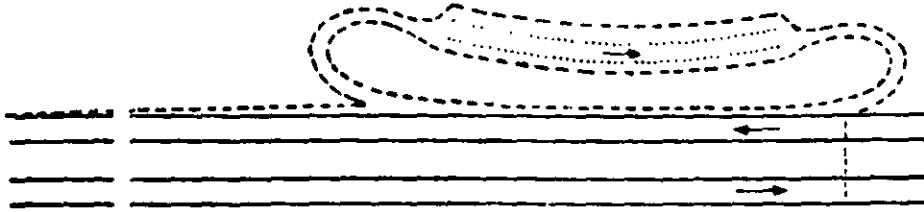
ZONA DE DESCANSO APROPIADA PARA CAMINOS CON BAJOS VOLUMENES DE TRANSITO
